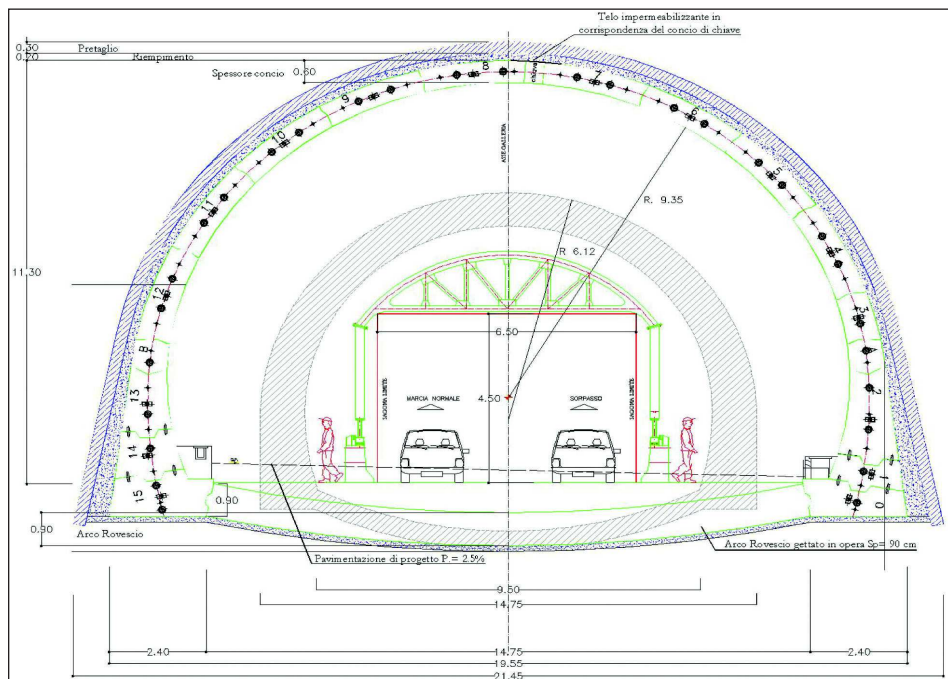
Sezione Tipo Progetto 2001 (Rocksoil S.p.A.).
